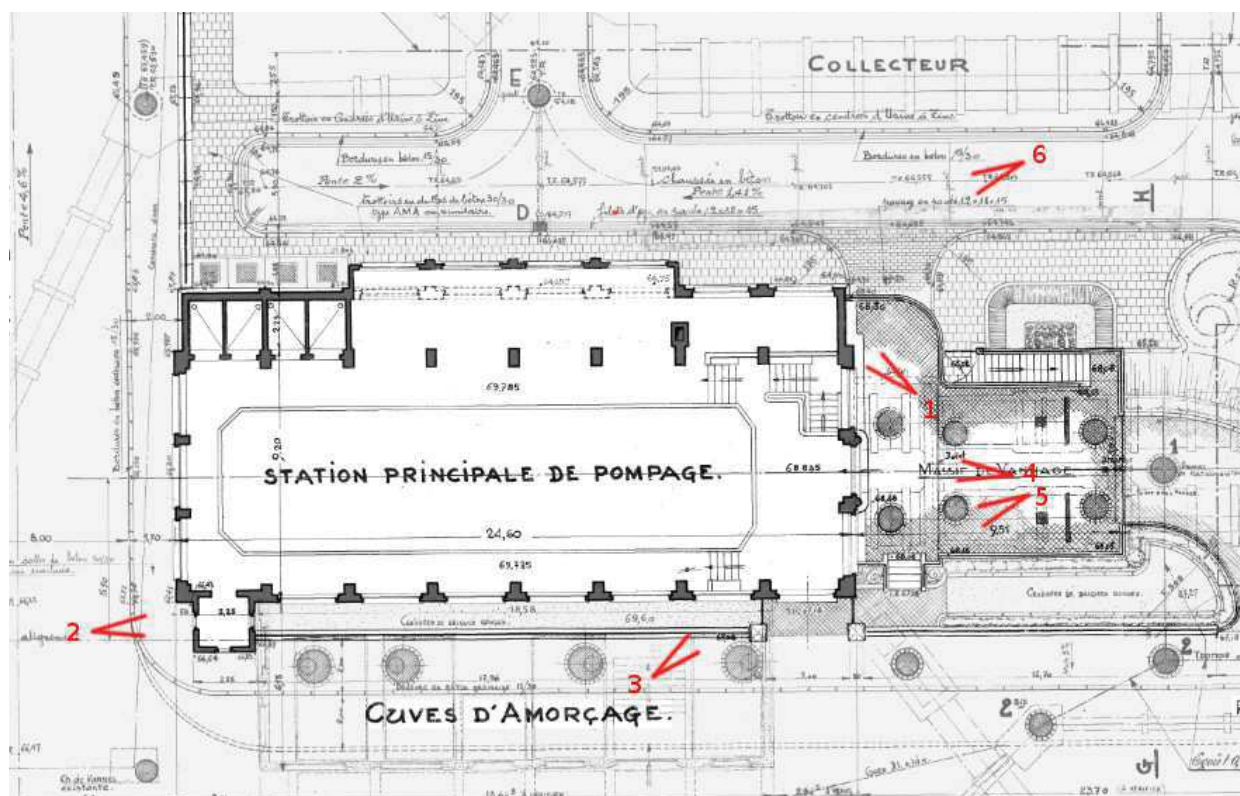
Plan de situation de la station de pompage Flémalle n°3
